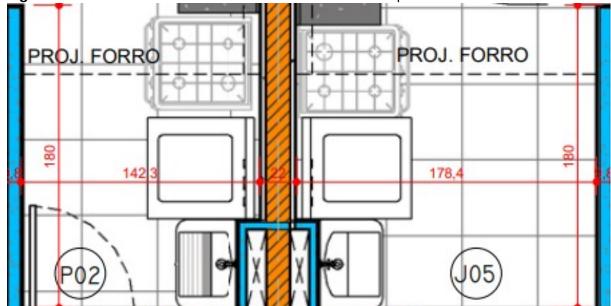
Detalhe do shaft com as dimensões erradas nos pavimentos térreo
